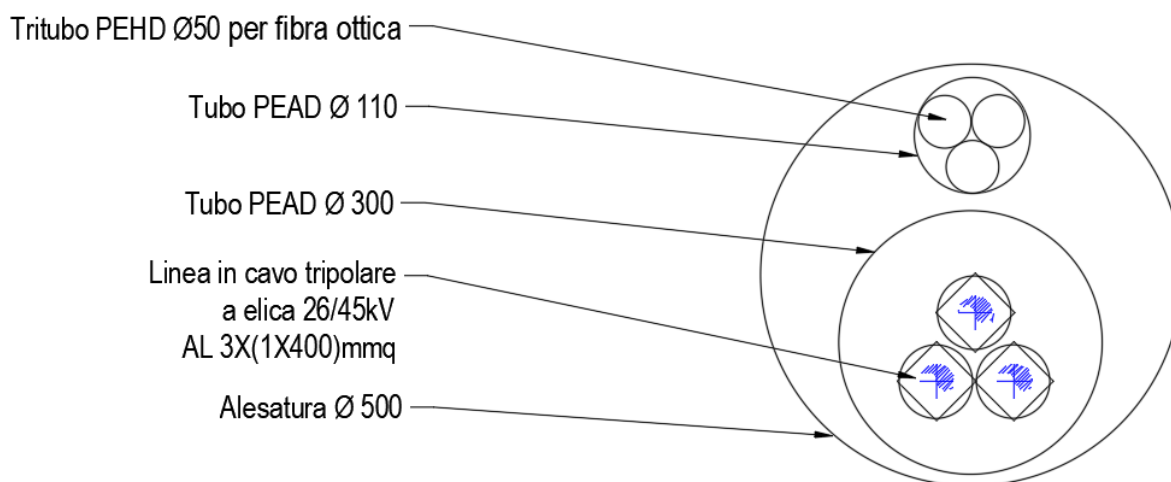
Sezione tipo del cavidotto scavato in T.O.C.
